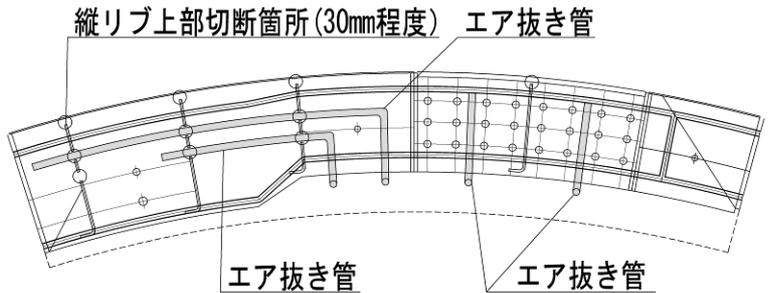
鋼殻ブロックにおけるエア抜き管の配置図(平面図)
